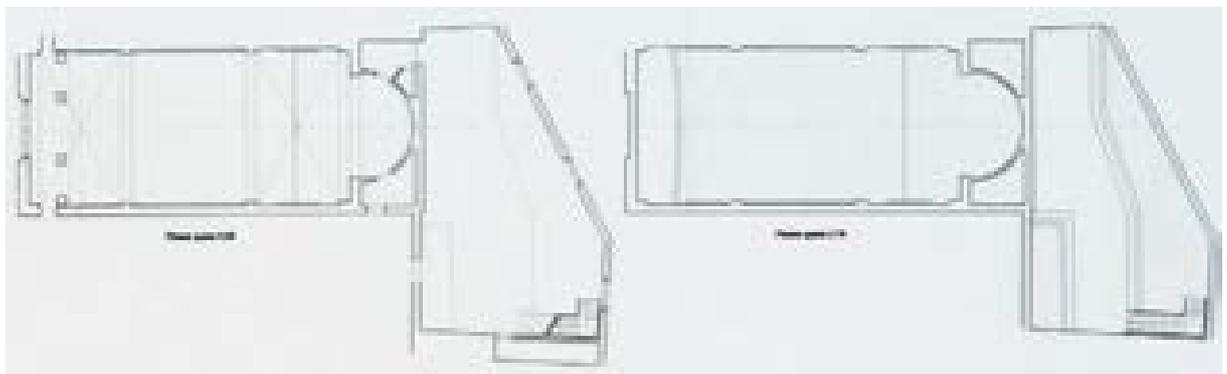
Pianta – Stato attuale – Bruno Sacchi – 10/06/2003 (AABS-94.210)
